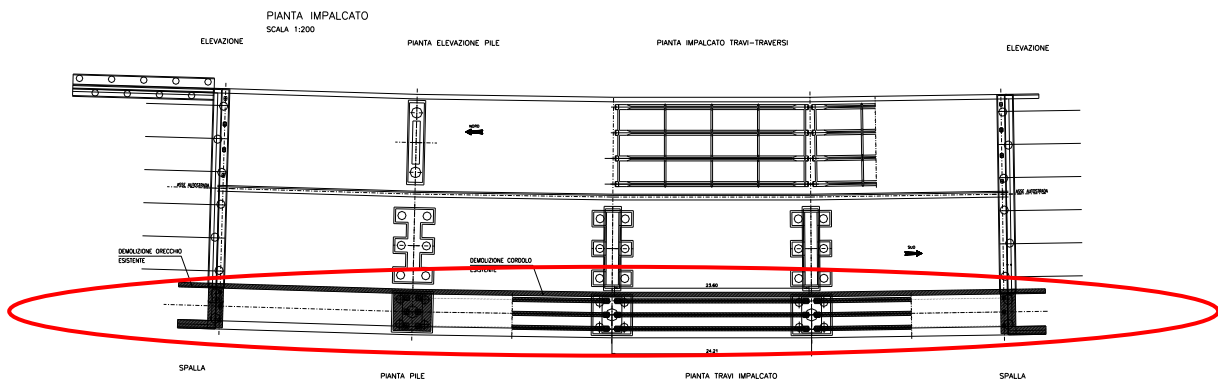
Pianta dell'impalcato del viadotto Zuane nella configurazione di progetto. La porzione di nuova realizzazione è quella nell'ovale rosso in basso
